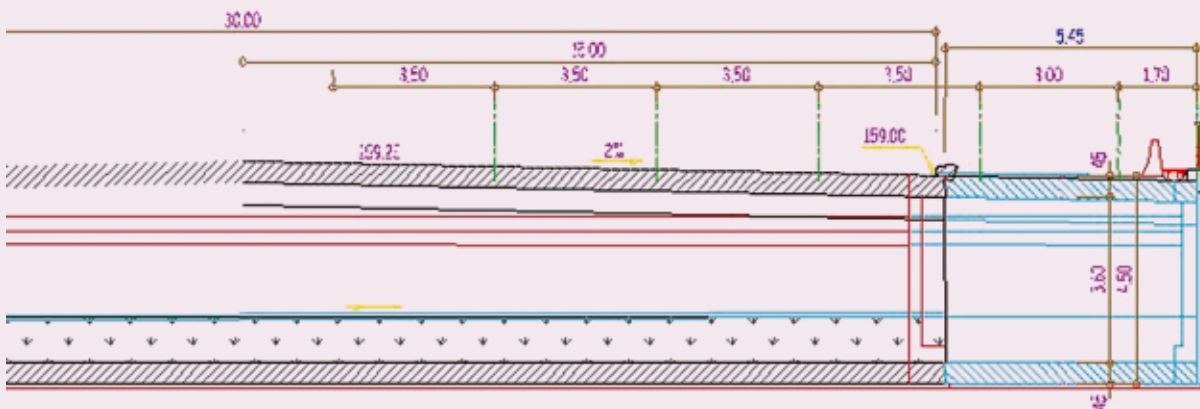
AU51, coupe transversale avec élargissement – Source : CETE de l'Est
